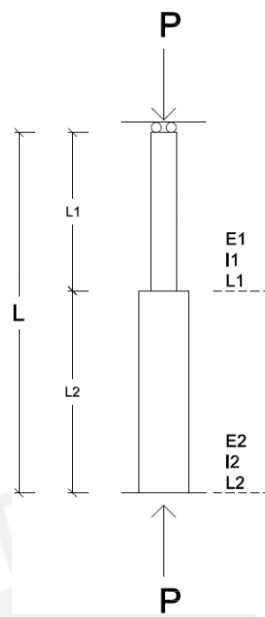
Columna de sección compuesta. Apoyos empotrado-móvil.
